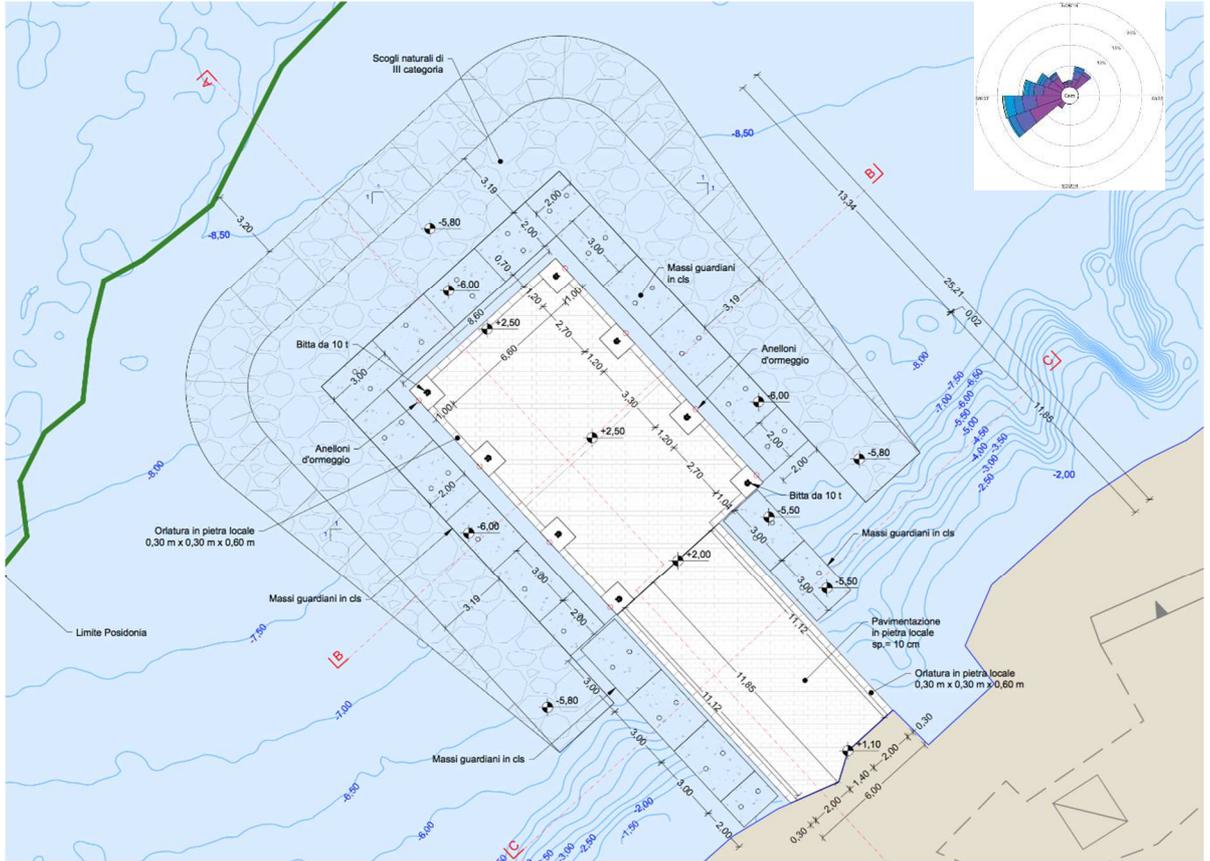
Soluzione di progetto definitivo 2021 sottoposta ad esame (Alternativa 1). Planimetria.
